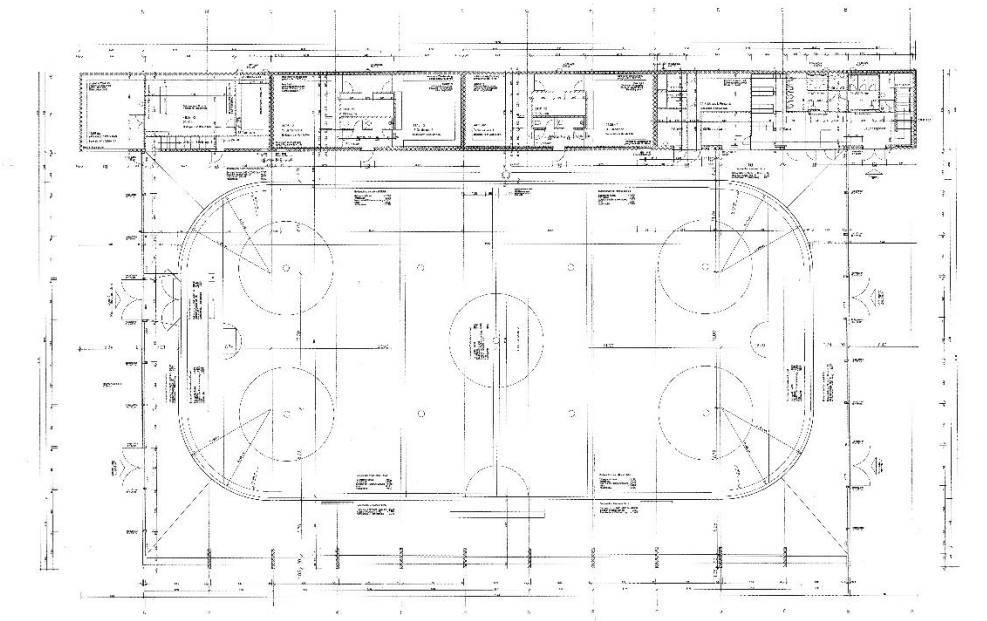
Grundriss Erdgeschoss Eishalle
